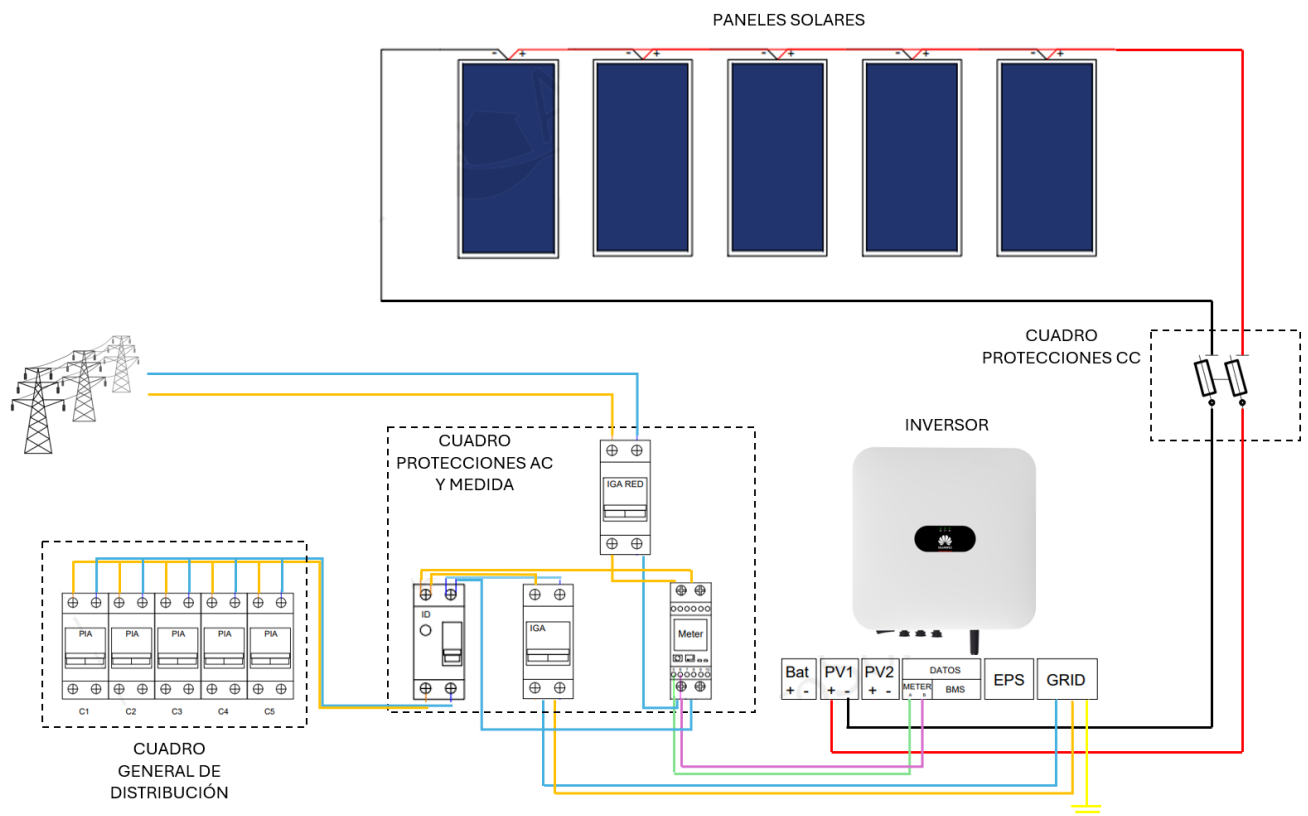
Esquema del cableado del conjunto de la instalación. Elaboración propia.
